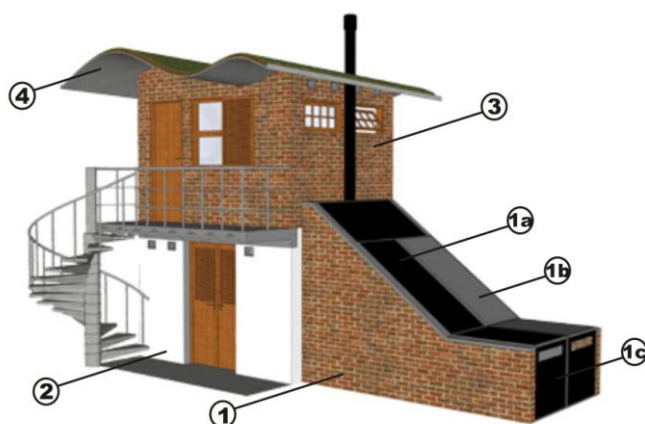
Vista da maquete – fachadas leste e norte (Autor: Lucas Sabino Dias).
